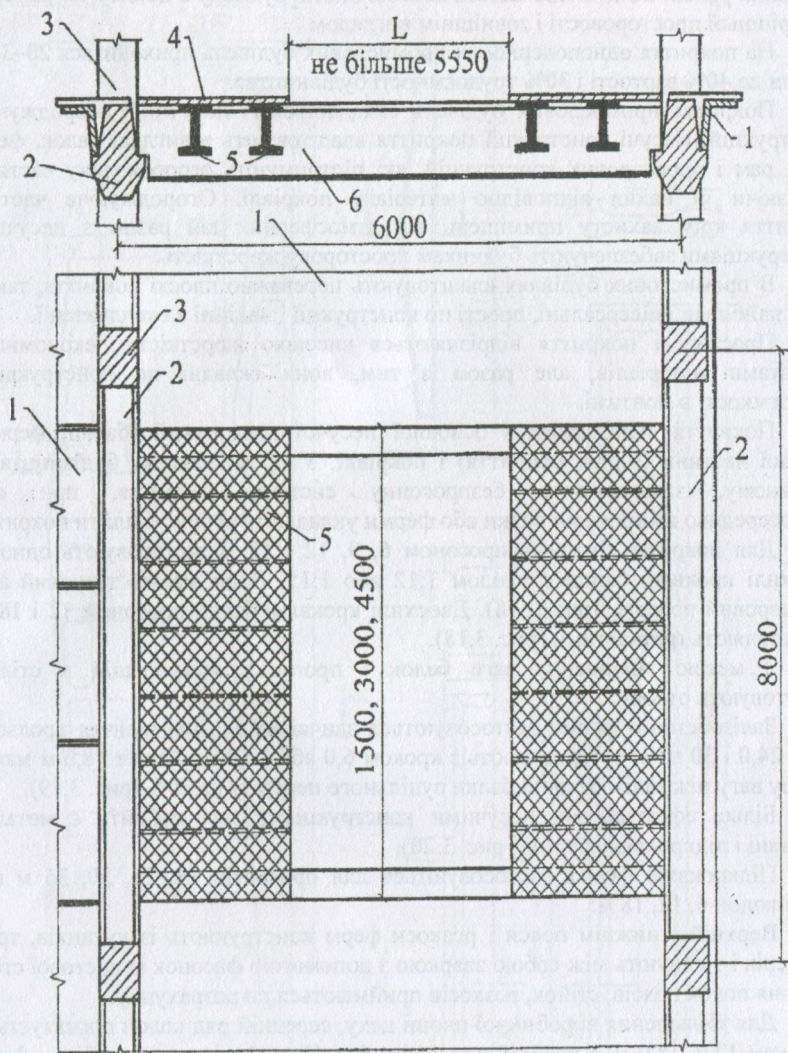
Монтажний отвір в міжповерховому перекритті: 1 - плита перекриття; 2 - ригель; 3 - залізобетонна колона; 4 - настил з листів рифленої сталі, підсилених ребрами; 5 - другорядна сталеві балка; 6 - головна балка.
